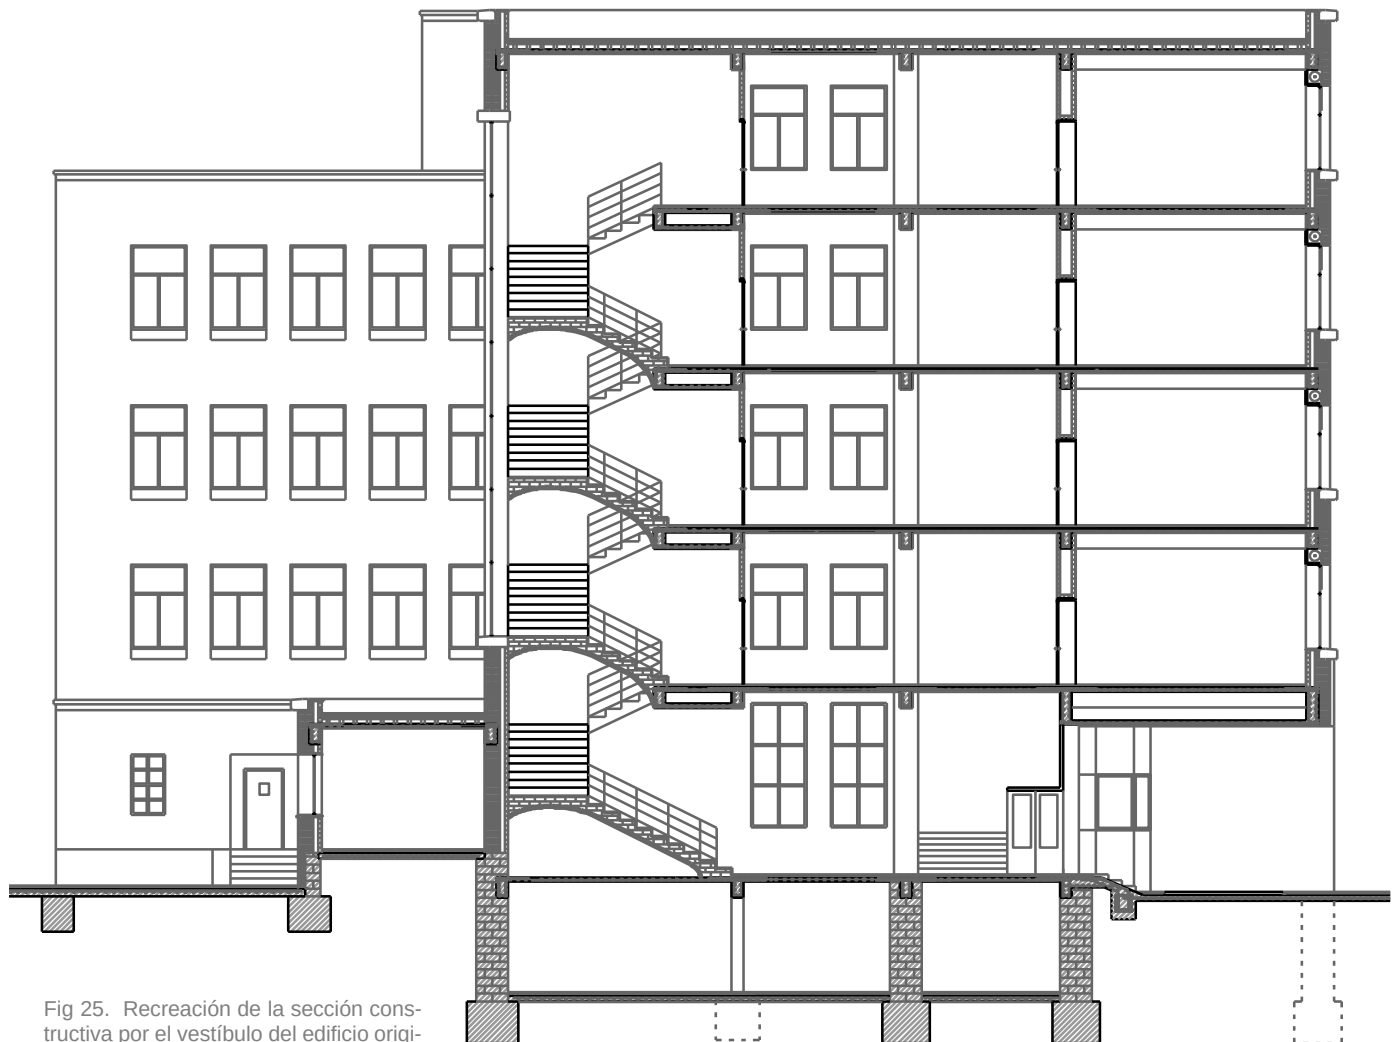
Recreación de la sección constructiva por el vestíbulo del edificio original de los Borobio.
